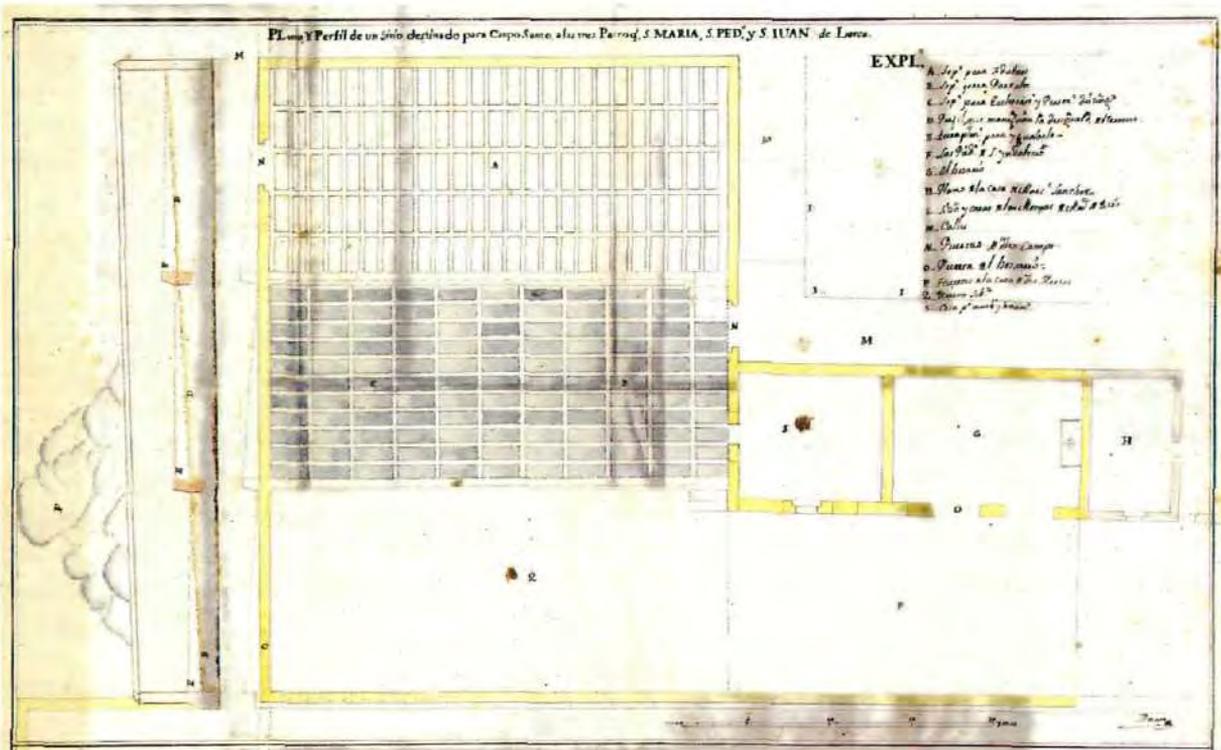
Plano y perfil del camposanto de las parroquias de Santa María, San Pedro y San Juan. Sebastián Morata. 1804.
